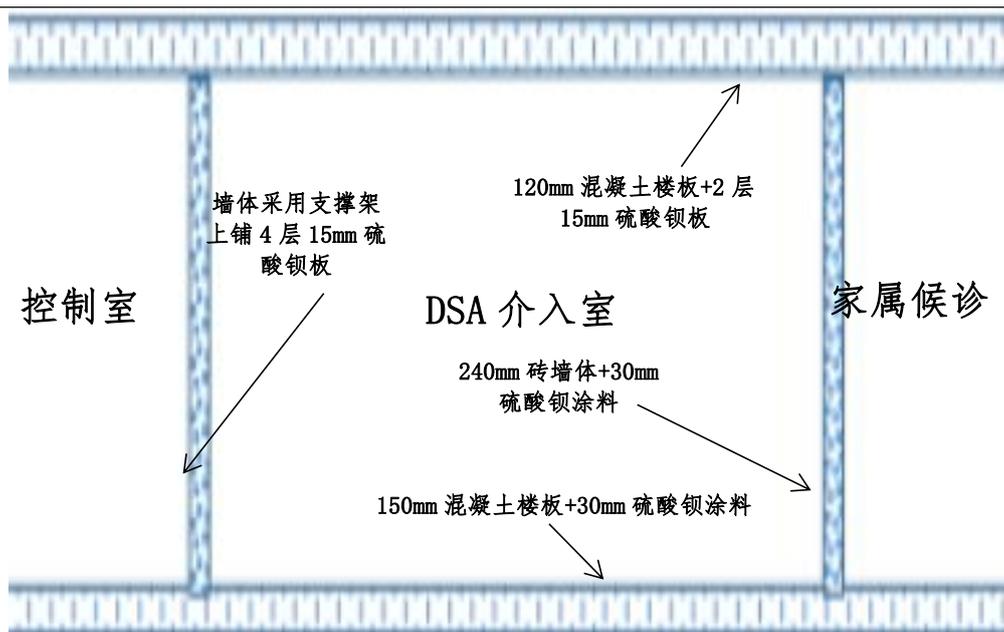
本项目 DSA 介入室屏蔽防护设计剖面图
